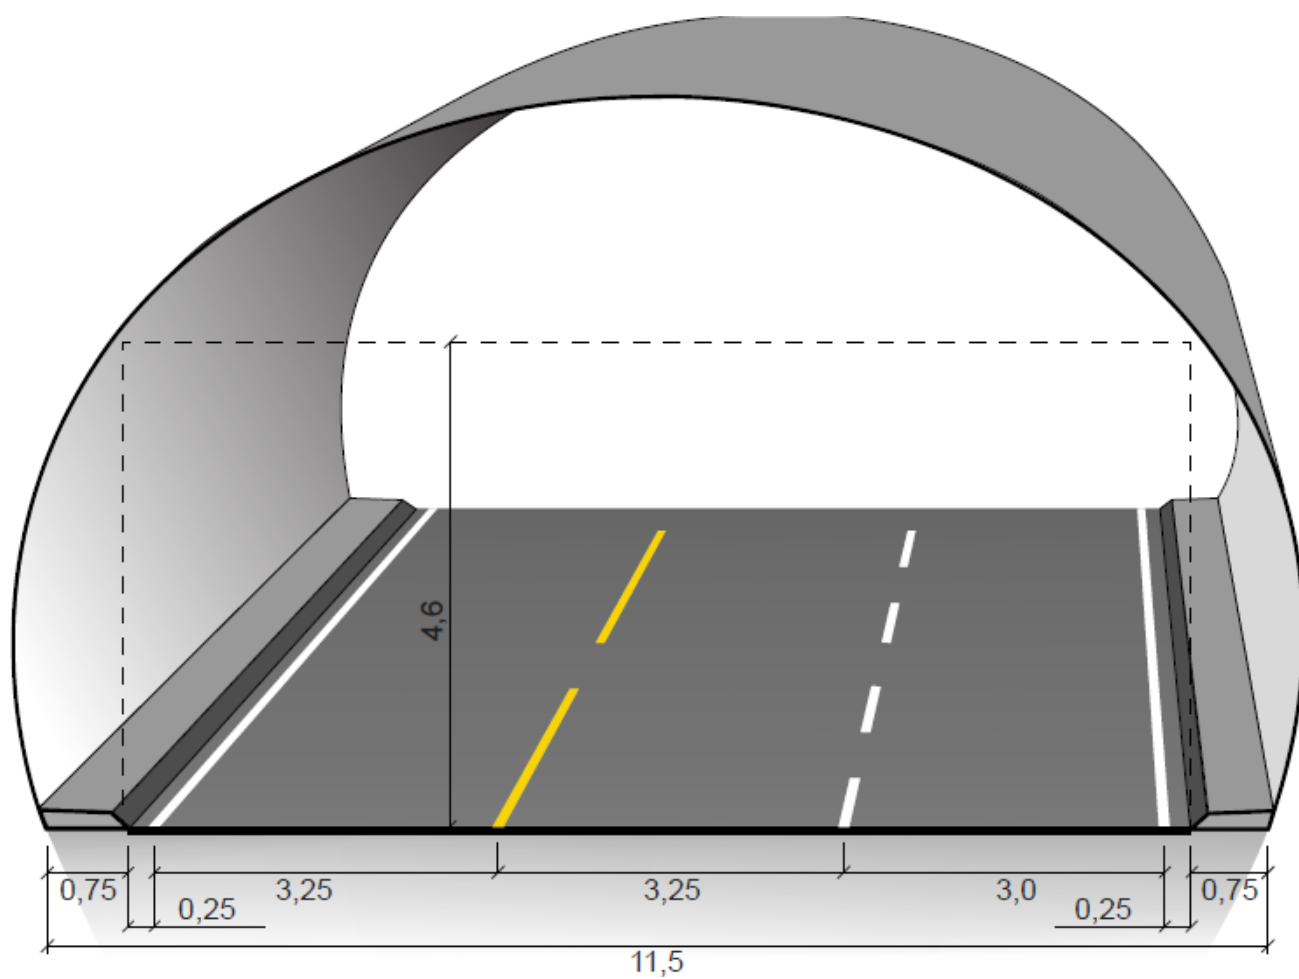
Tunnelprofil T9,5 (mål i m).
